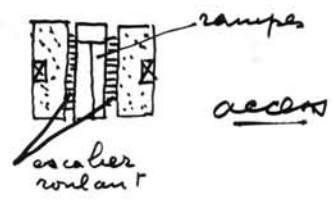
ESQUEMAS, PLANTAS, CORTE E FACHADA
